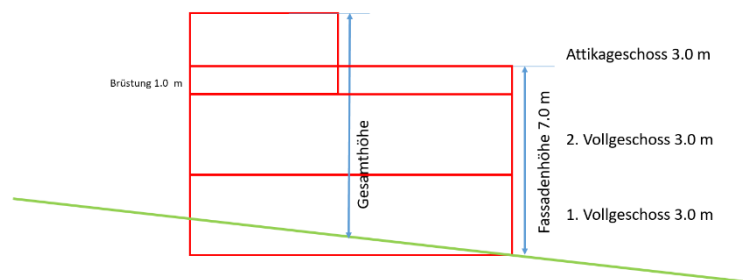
Flachdachbau W2 mit Attika am Hang mit neuen Höhenmassen
